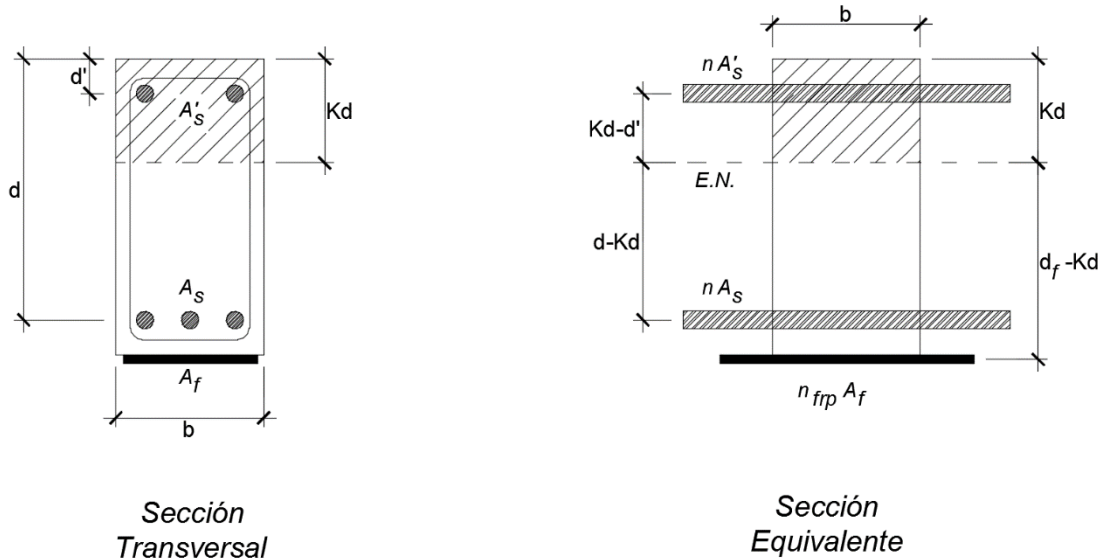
Sección transversal de concreto armado reforzado con FRP y Sección agrietada equivalente.
